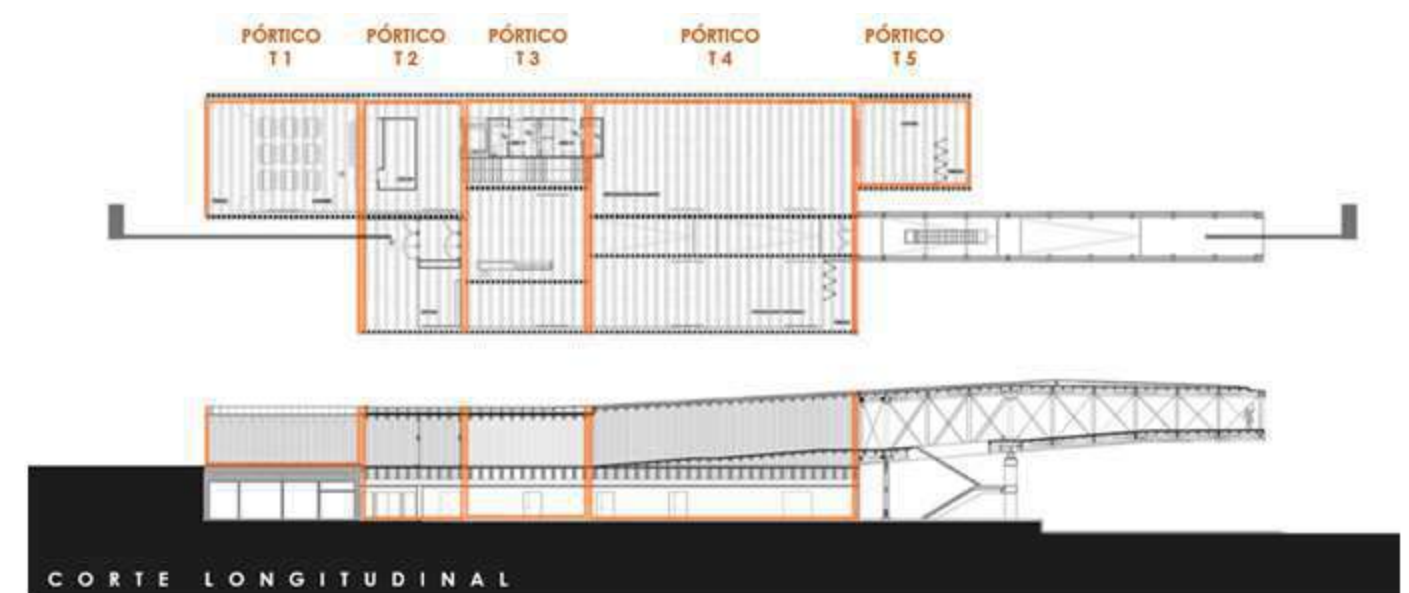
Tipos de pórticos. QVE arquitectos (2008). [Editado por Jade Castellanos].
